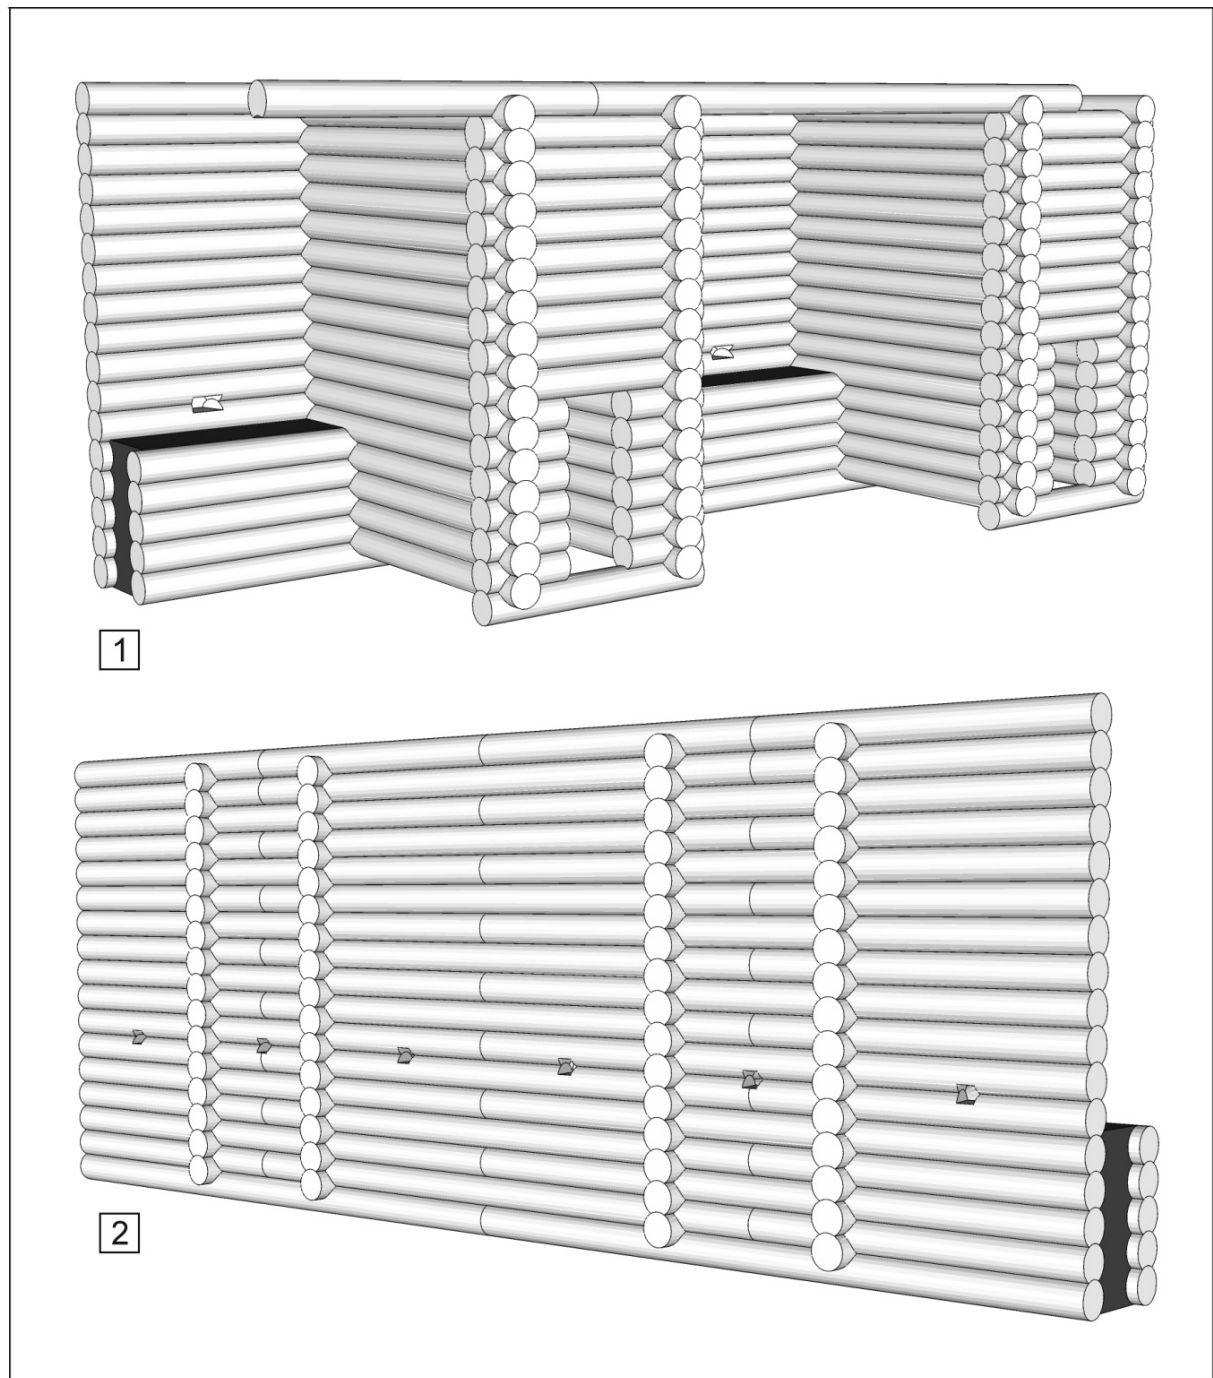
Реконструкция тарасных стен в Олонце по описанию 1649 г.
